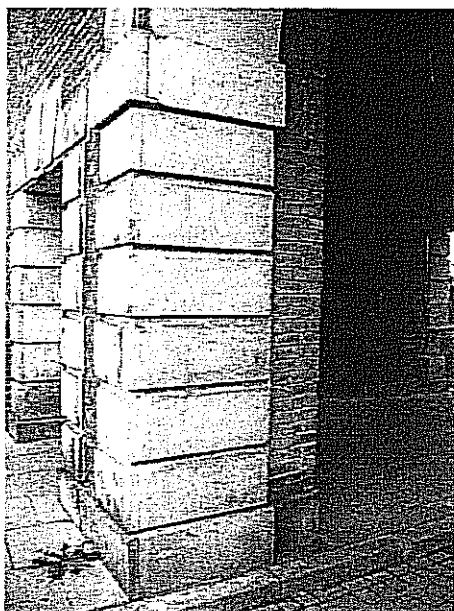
Korozja i brak płyt kamiennych nad przejściem dla pieszych, po stronie Placu Zamkowego.
